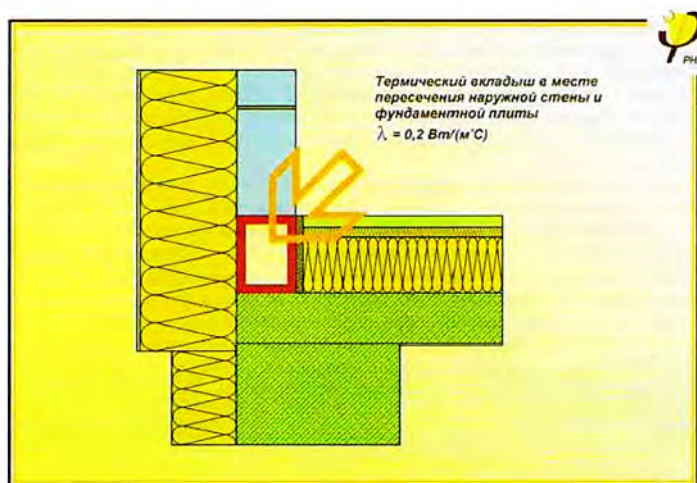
Стык с минимальными теплотерями между теплоизоляцией плиты перекрытия над подвалом и теплоизоляцией наружной стены
